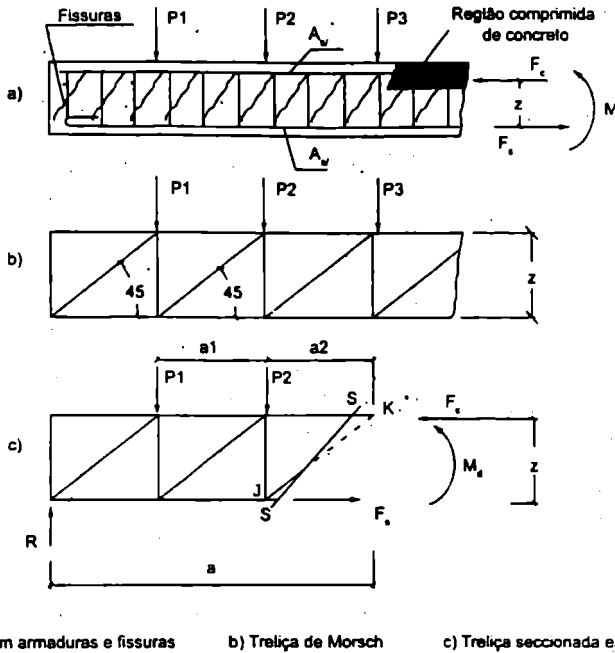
Modelo de treliça de Morsch em uma viga simplesmente apoiada.
